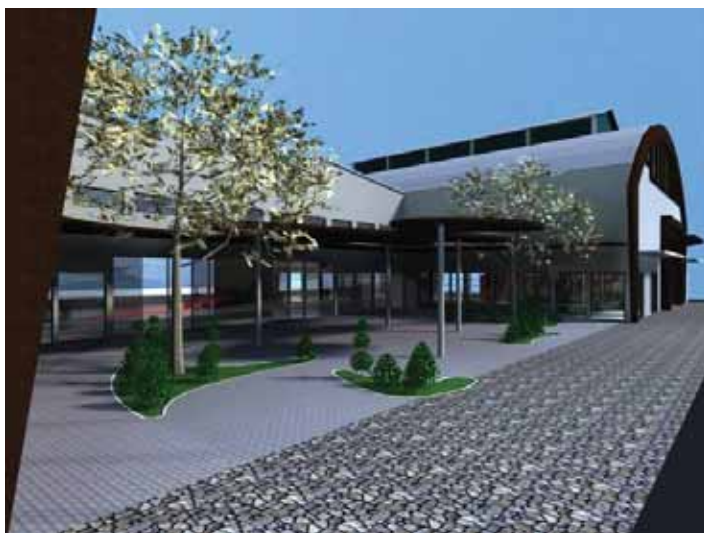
Vista da academia primeiro pavimento (fonte:Elton Maeda)
